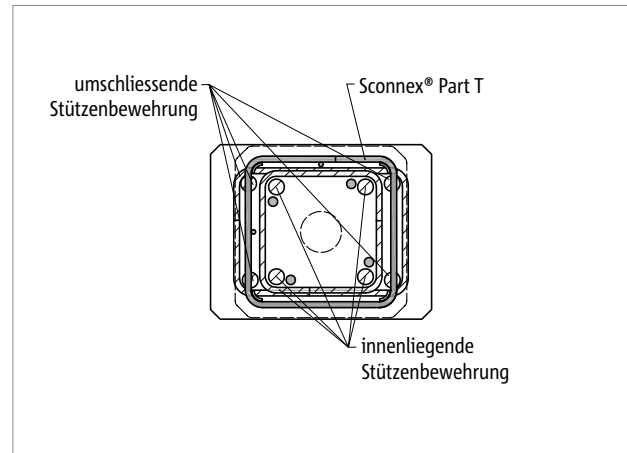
Schöck Sconnex® Typ P: Bewehrungsführung im Bereich 2 – Stützenquerschnitt
